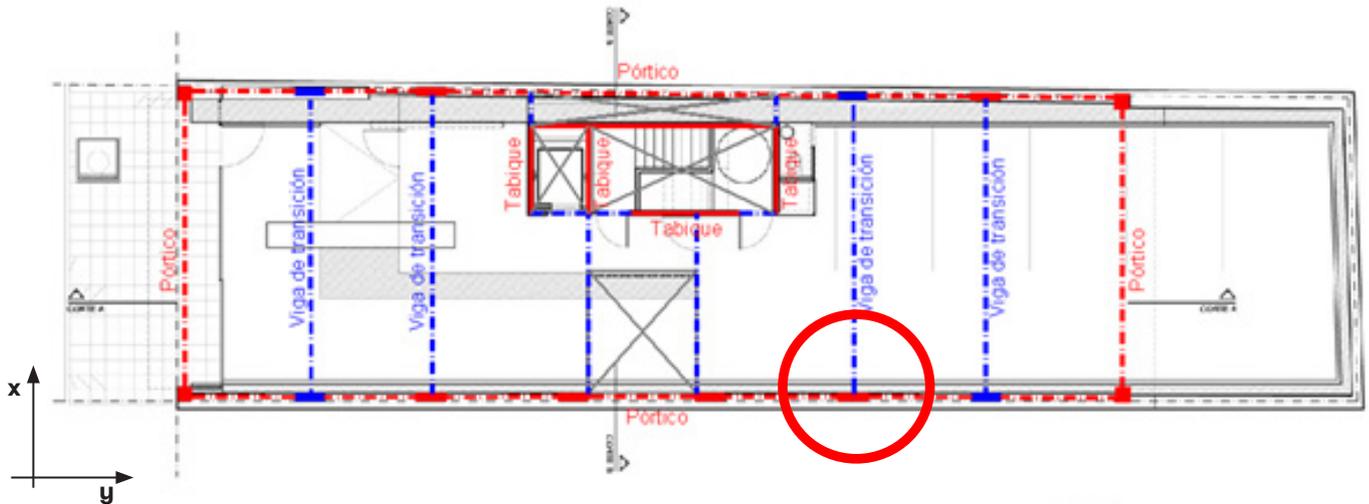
Esquema estructural losa sobre planta baja y direcciones de análisis. Fuente: Elaboración propia
